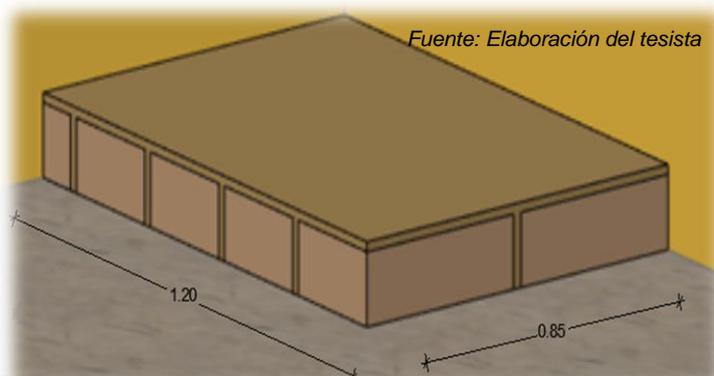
Instalación de la primera hilada para la cocina mejorada.
